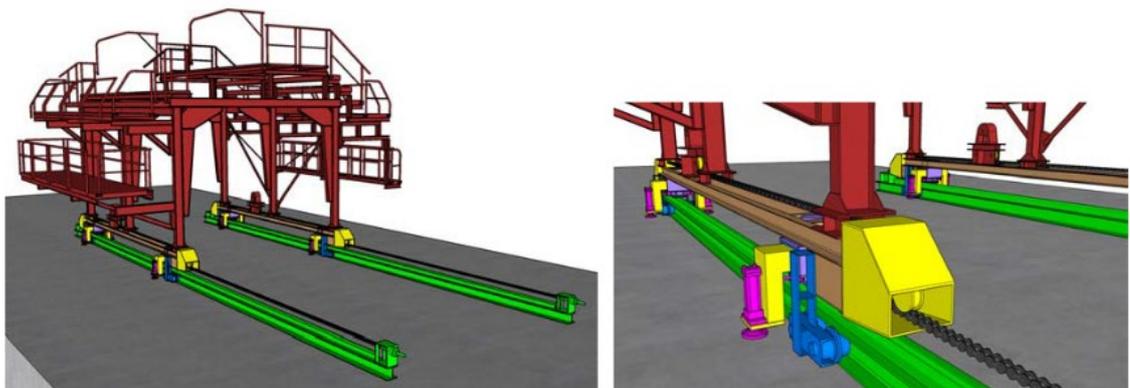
Rail Walker System のイメージ図(作業台車での採用例)
